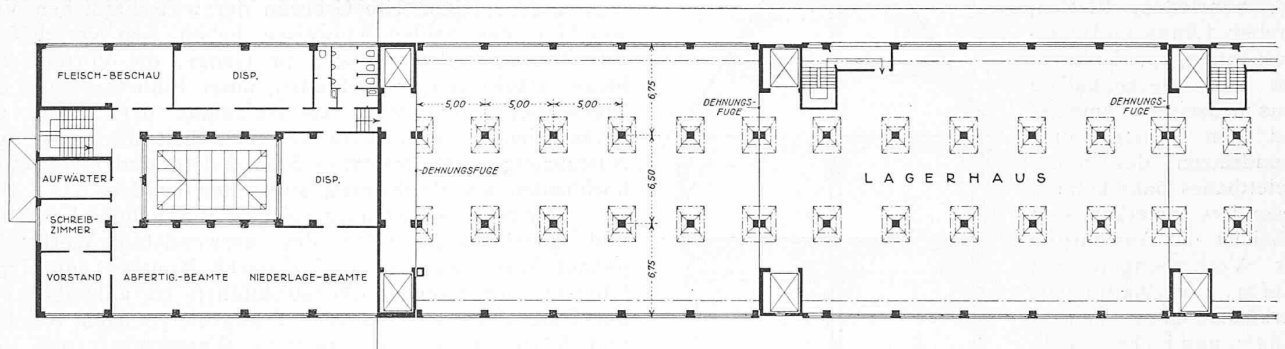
Grundriss des ersten Stocks, links Bureaugebäude, rechts Lagerhaus. — Masstab 1 : 500.
